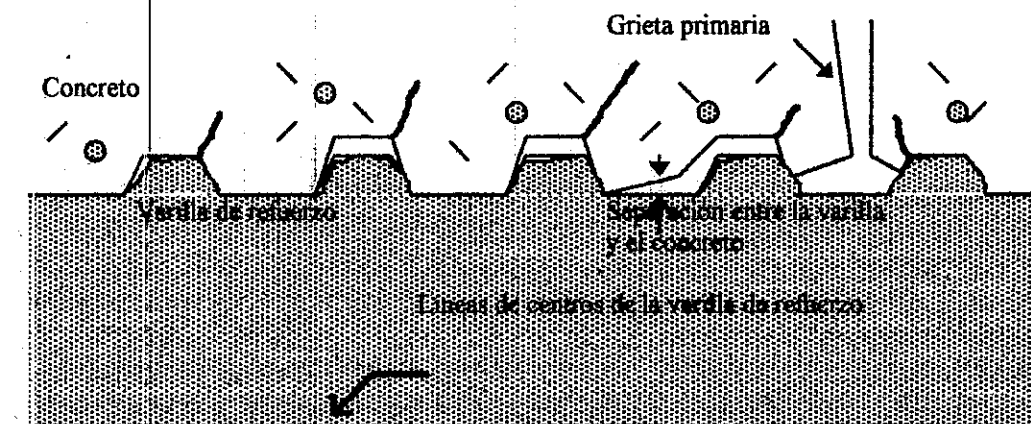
Sección a través de una varilla de refuerzo y concreto, que muestra la separación que ocurre cerca de una grieta primaria.
